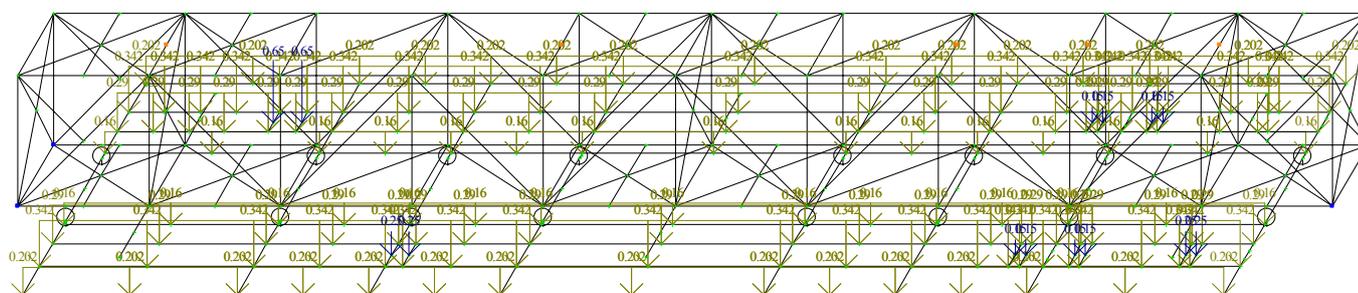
Вертикальные нагрузки от проектируемых трубопроводов и площадок
